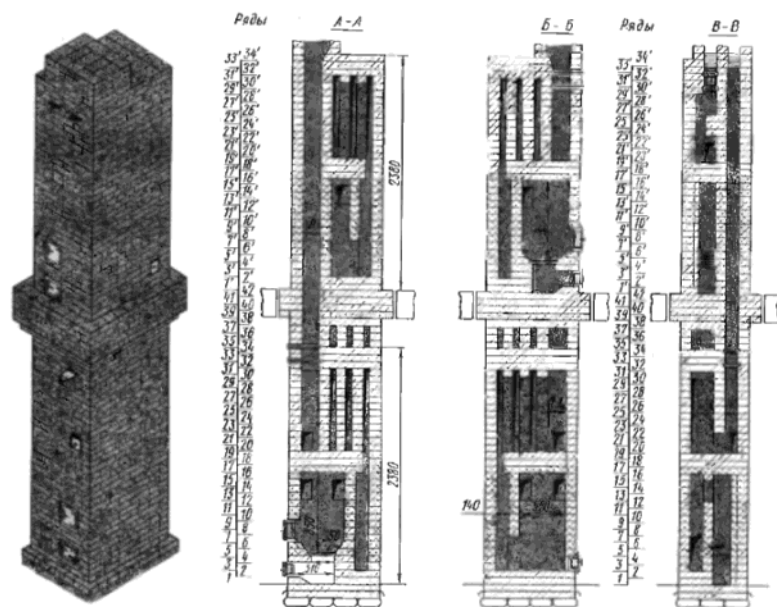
Типовая двухъярусная печь ПТД-4400/3500
